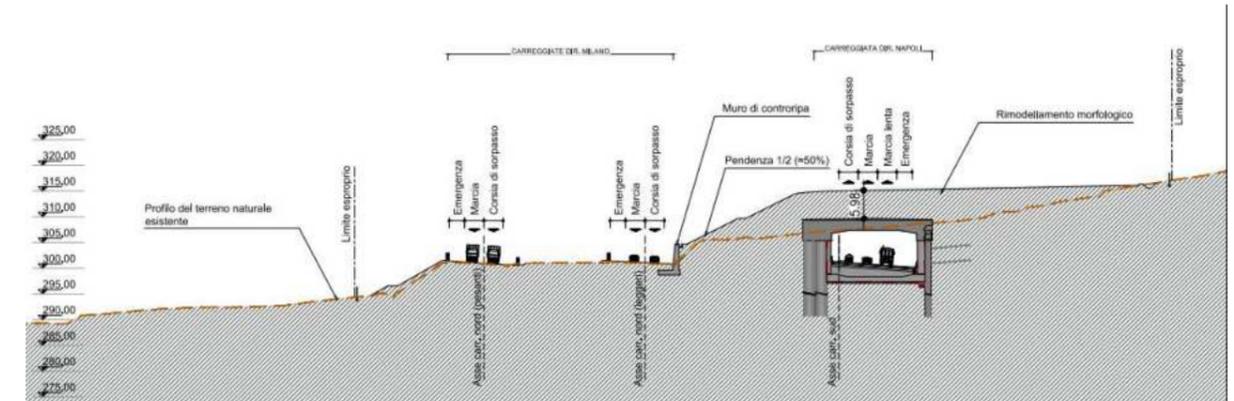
Sezione tipo corrente lungo la galleria
